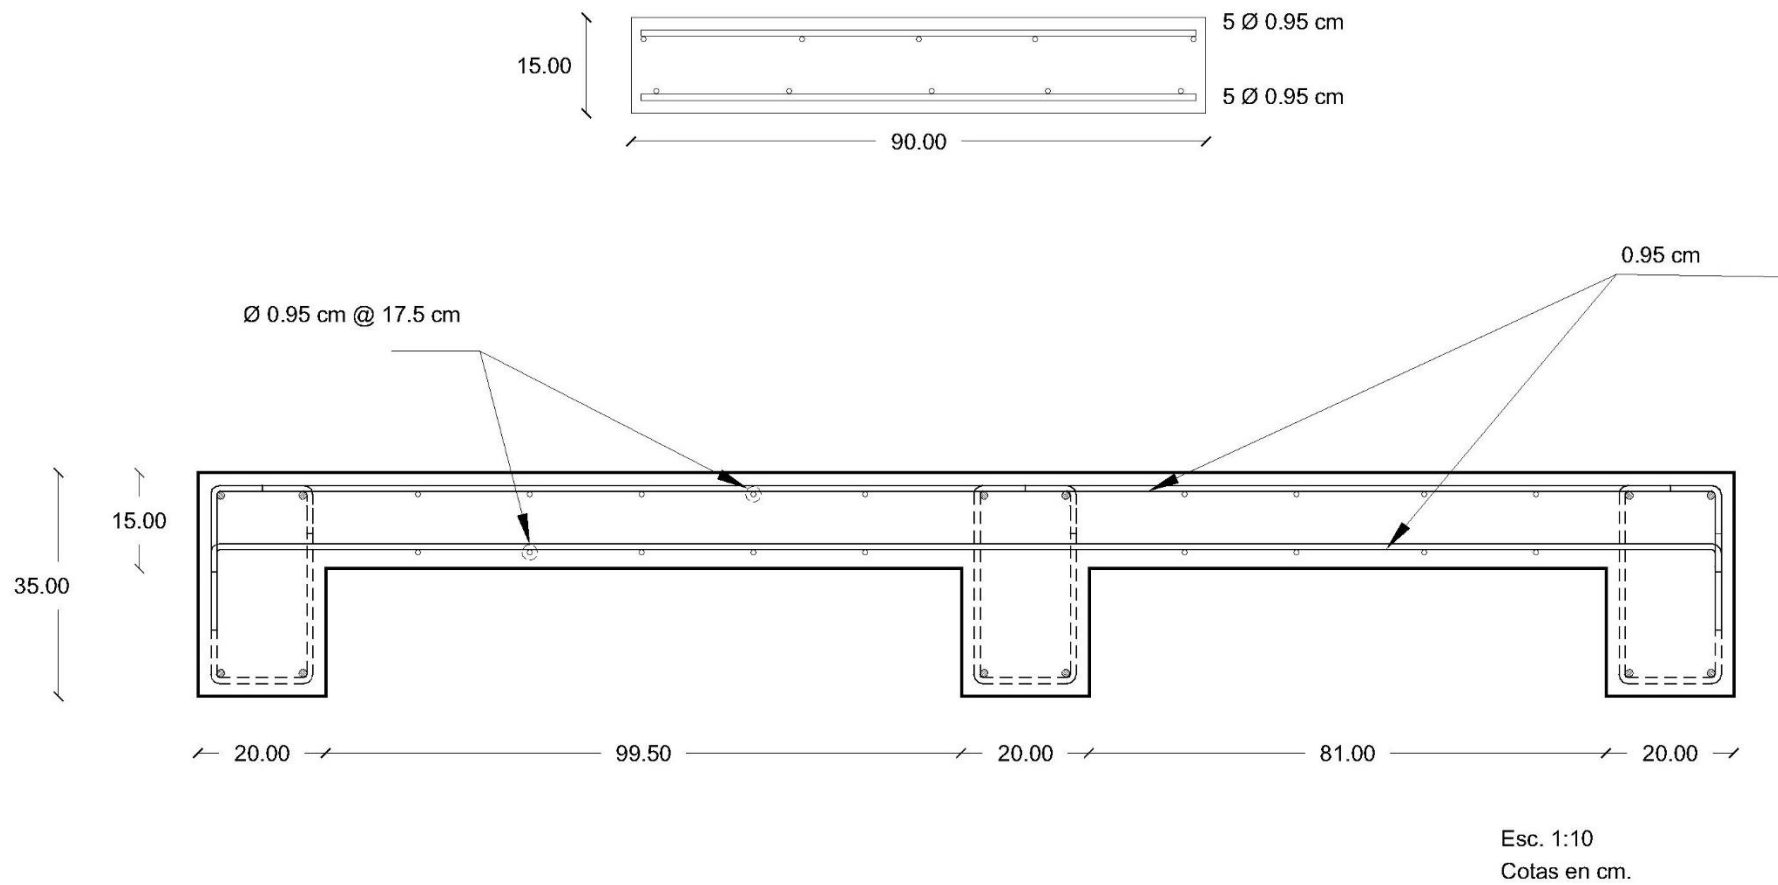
Detalles de la losa de reacción móvil (corte transversal A-A' y B-B').
